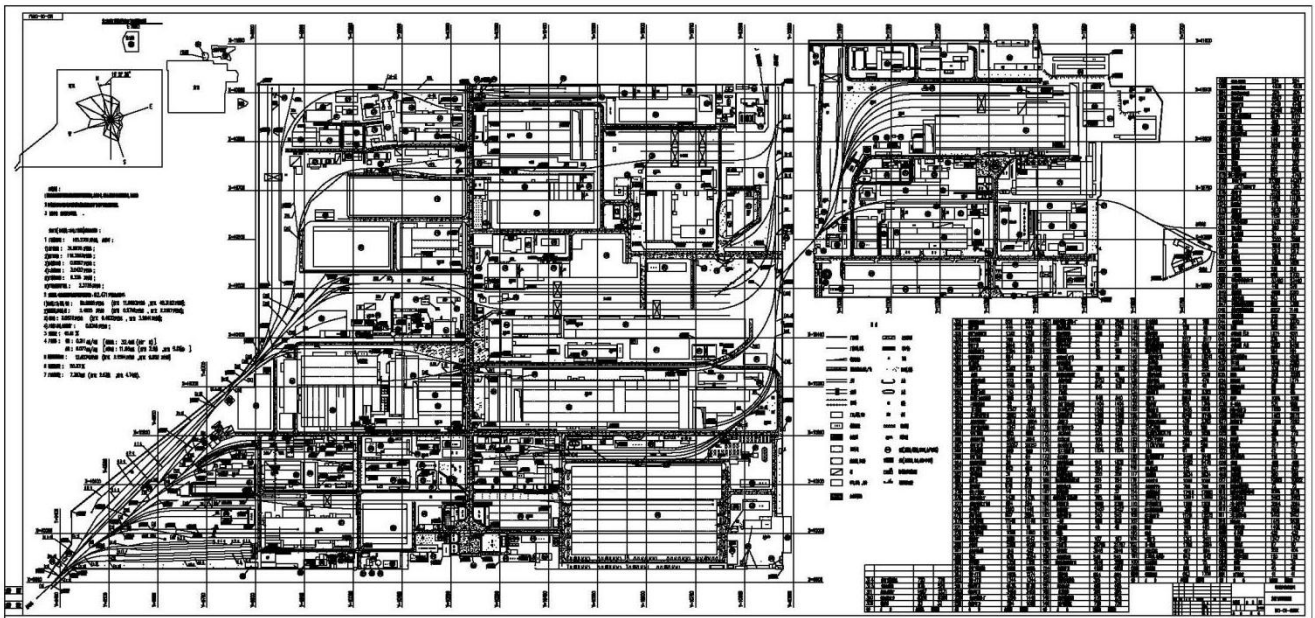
中车齐齐哈尔车辆有限公司厂区平面图
